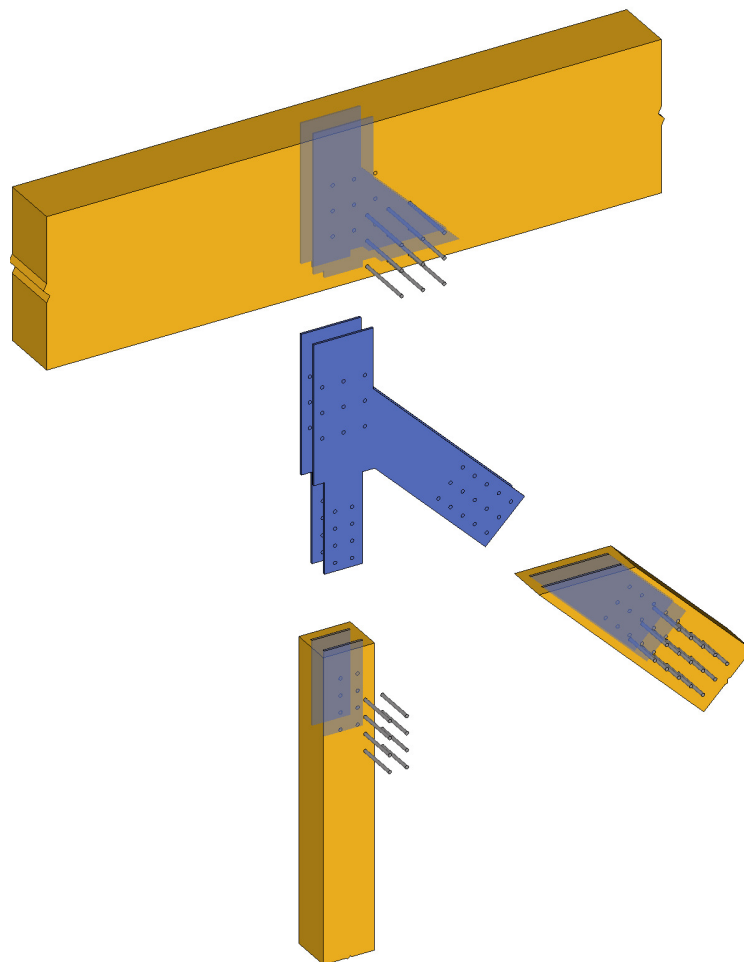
Explosionszeichnung des Anschlusses für Fachwerk FA2.j
